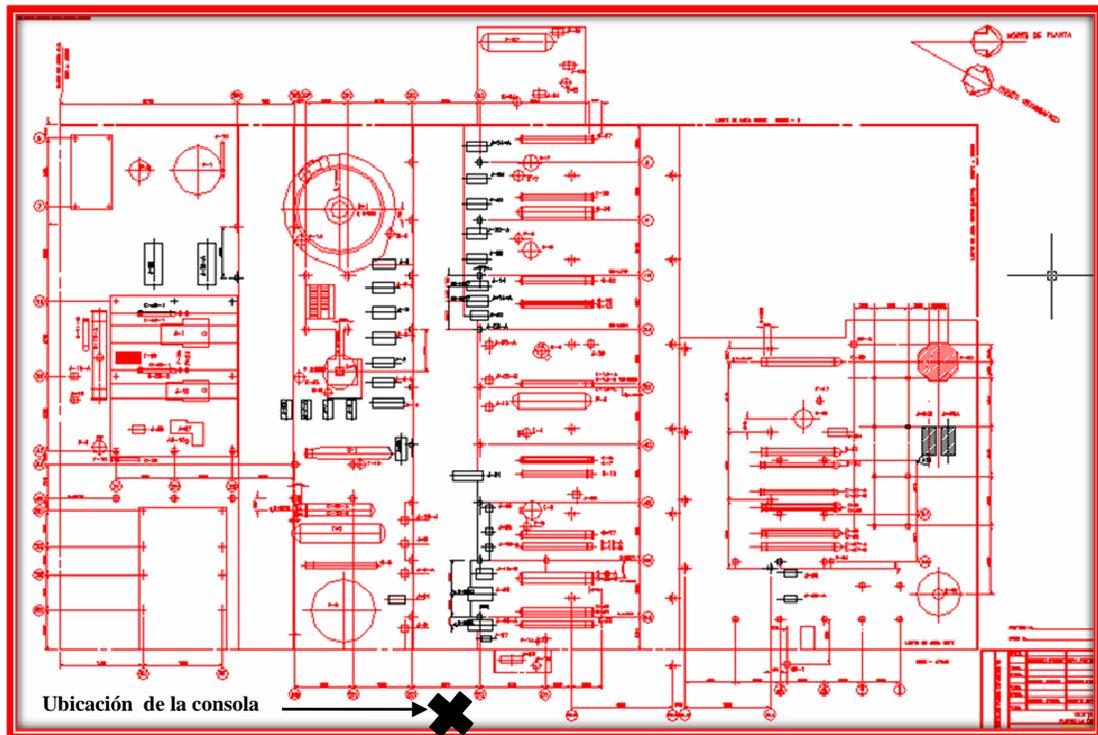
Plano de la planta con ubicación de la consola de generación en planta
